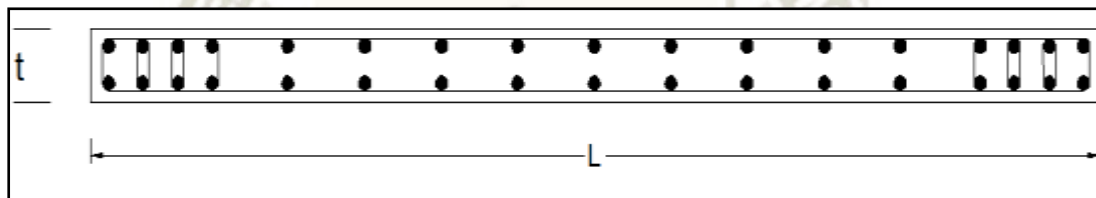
46.-Esquema en planta de un muro de concreto armado.
